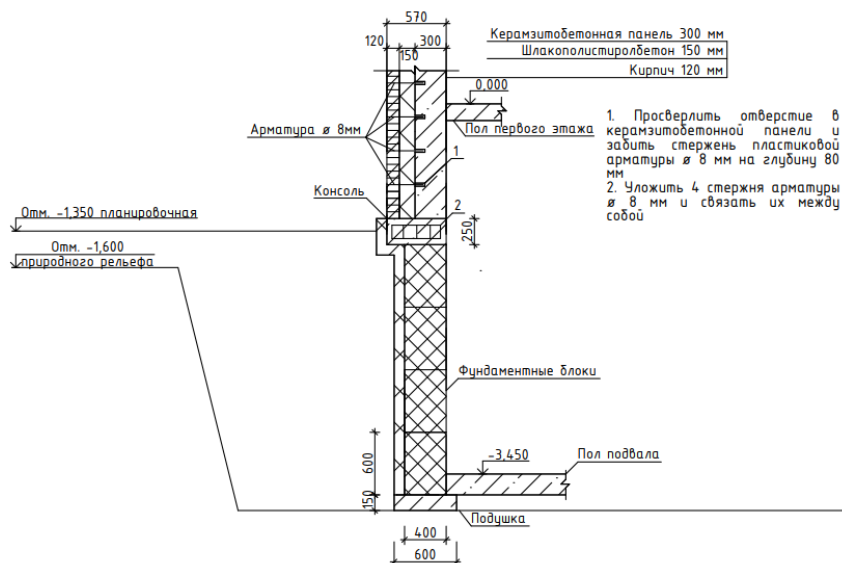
Разработка котлована больших размеров с использованием фундаментных блоков с пиллястрой
